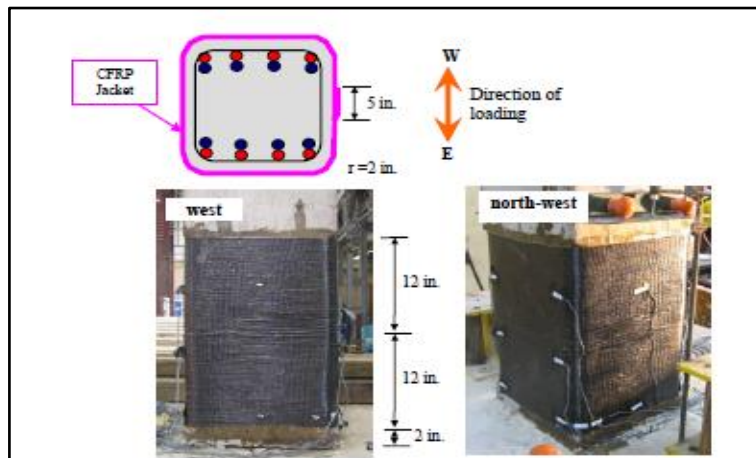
Chaqueta de CFRP para columna con Empalmes.
